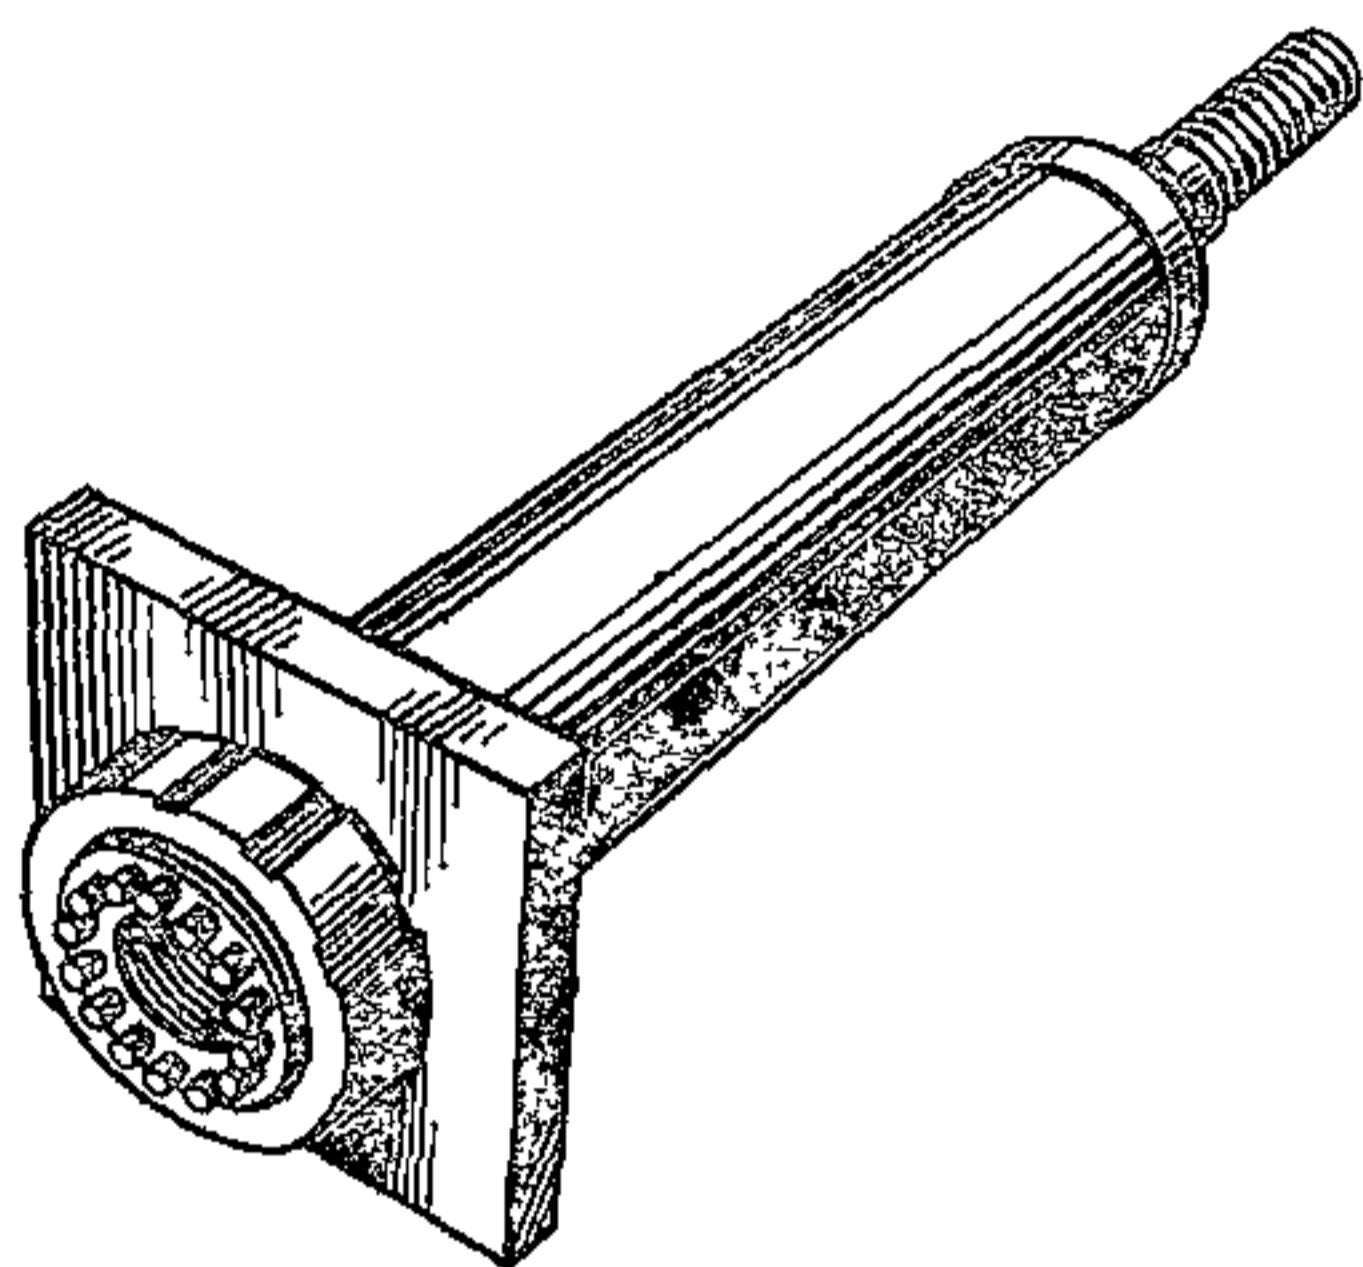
Арматурный элемент для натяжения на бетон конструкций с высаженными анкерными головками на проволоках
